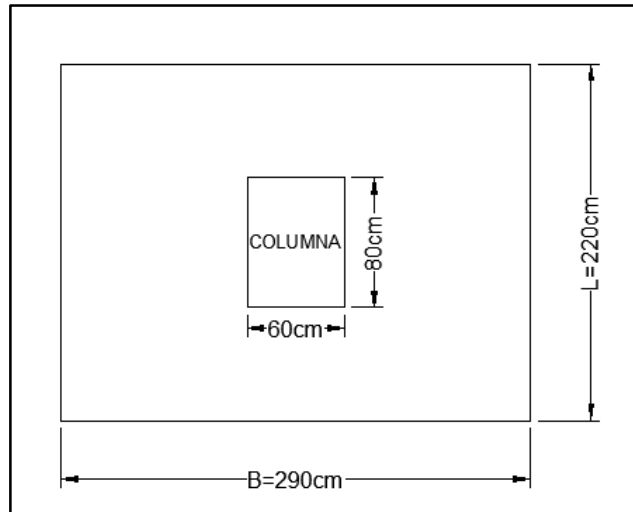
Vista en planta del dimensionamiento inicial de la zapata. Fuente del autor.
